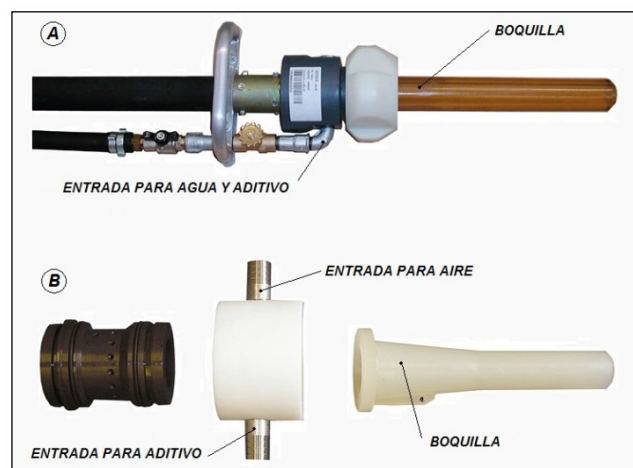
Boquillas para la colocación de concreto lanzado. A: vía seca; B: vía húmeda. [79] Sika AG (2011).
